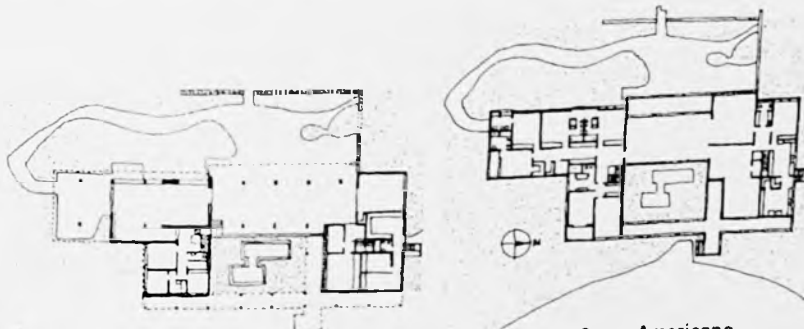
Croquis plantas pavimento inferior e superior casa Oscar Americano.
